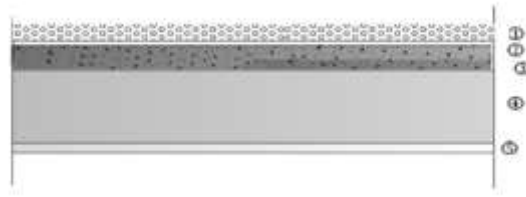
coupe de plancher en dalle pleine du balcon
